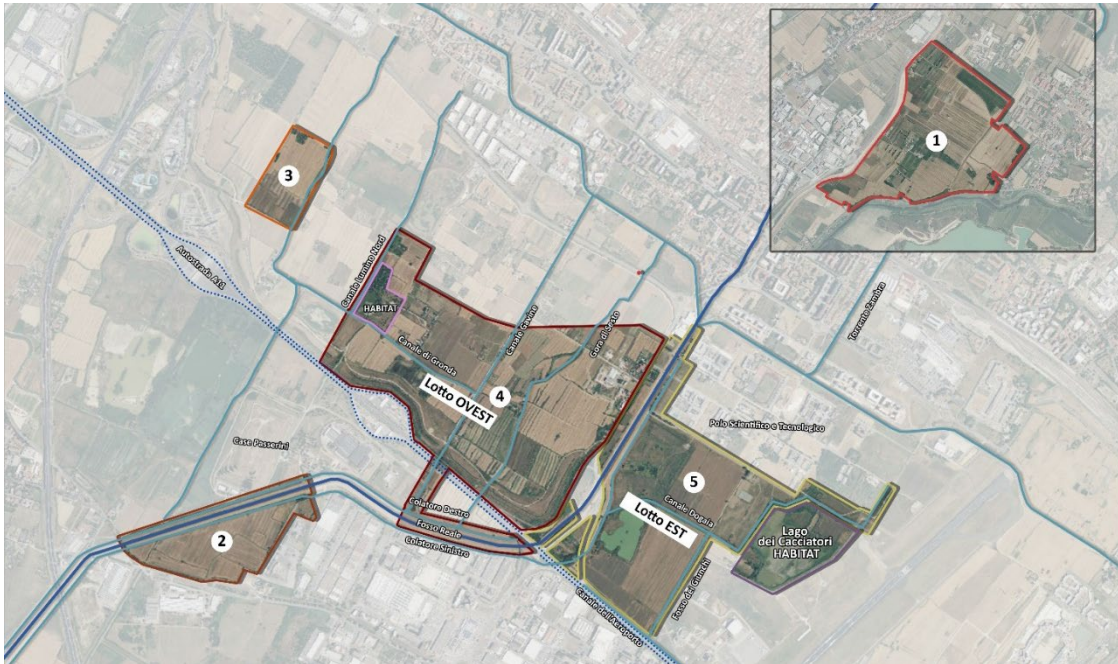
Planimetria di cantierizzazione: suddivisione in macro lotti
